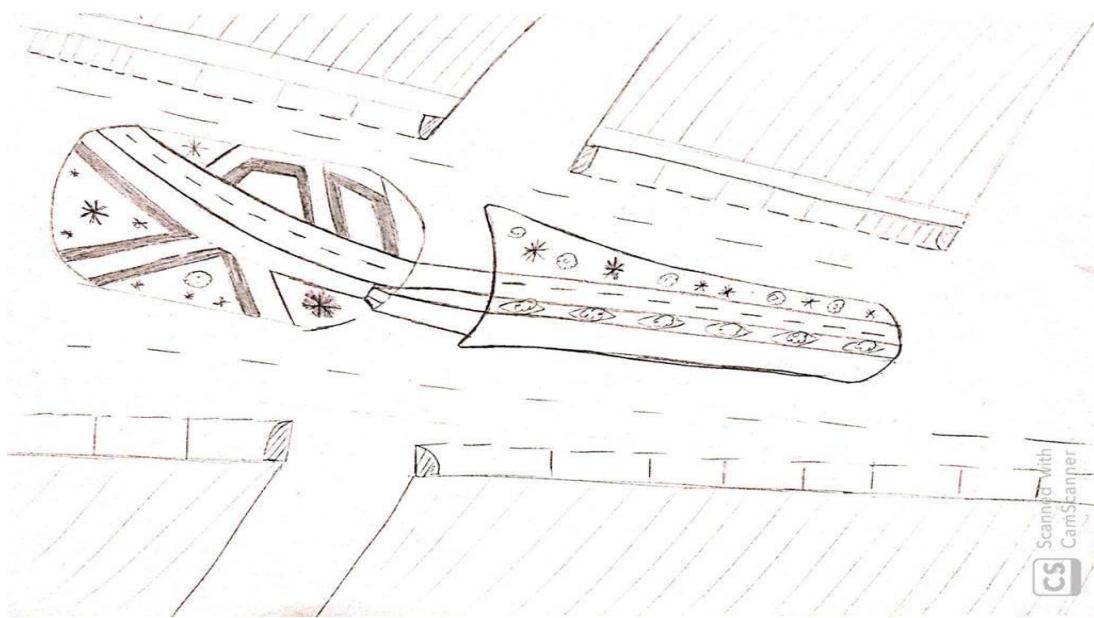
Croqui da intervenção em planta baixa canteiros central e avenida.
